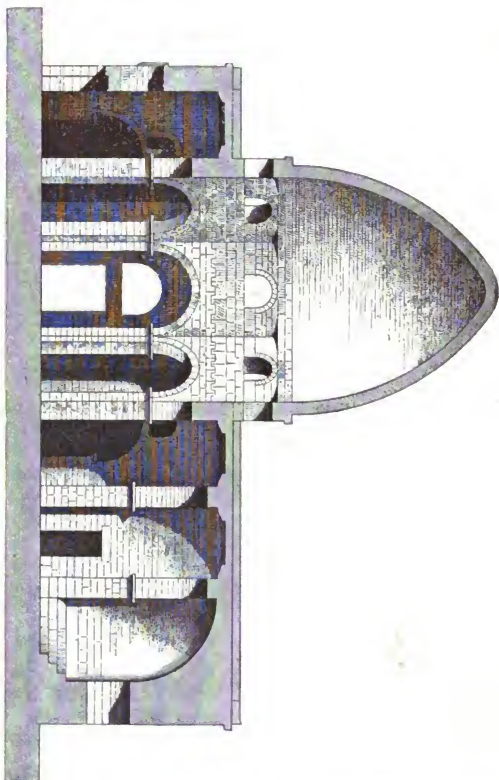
St. Georg in Esra. Grundriss.
